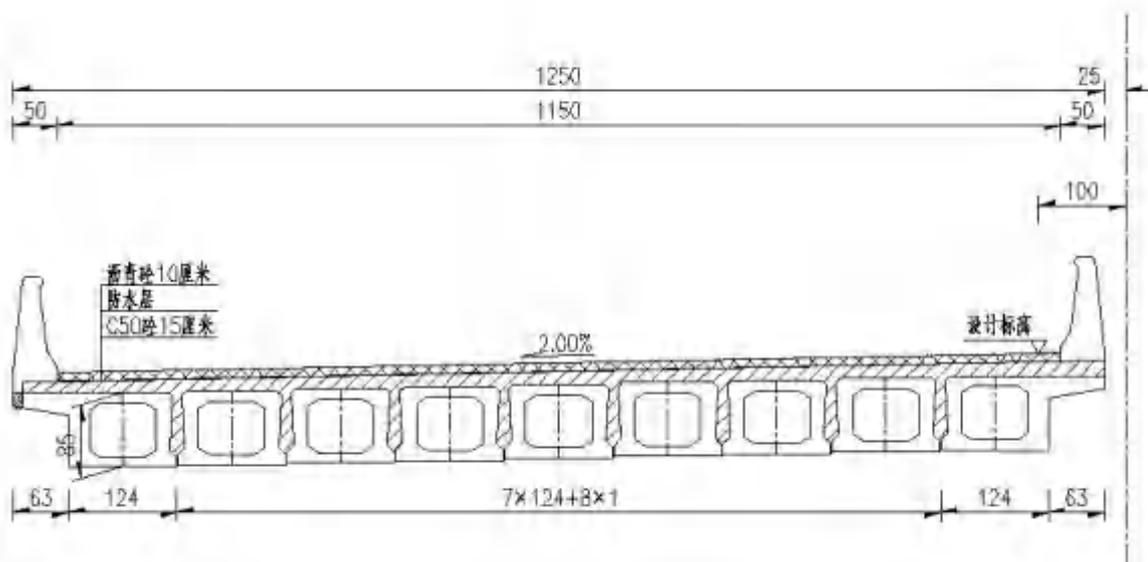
整体式路基段桥梁标准横断面图（单位mm）
